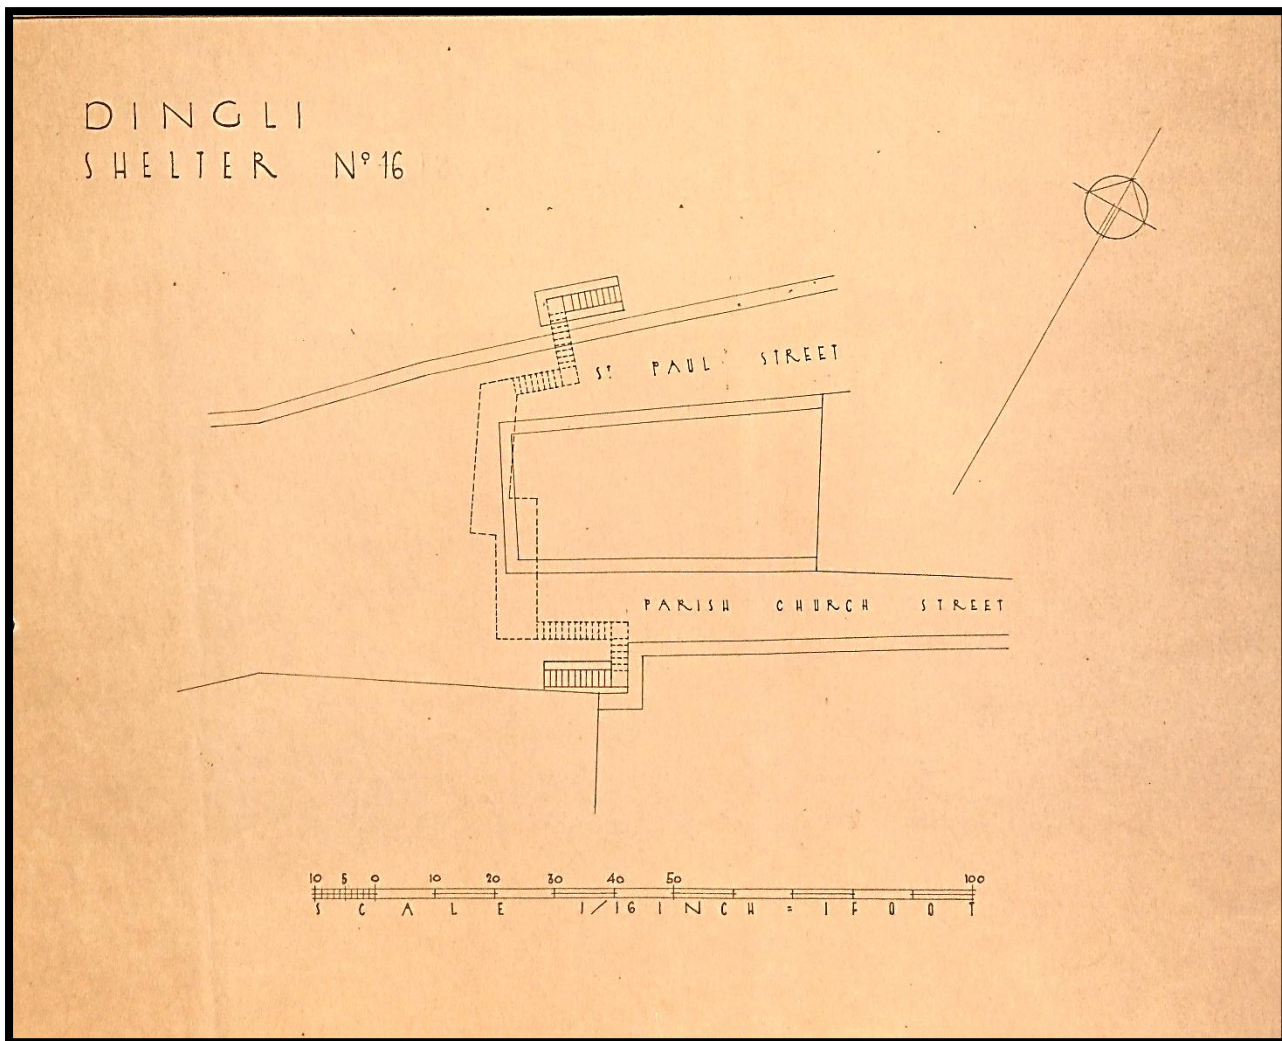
Planta do Abrigo nº16 (12) "Saint Paul Street – Parish Church Street."
